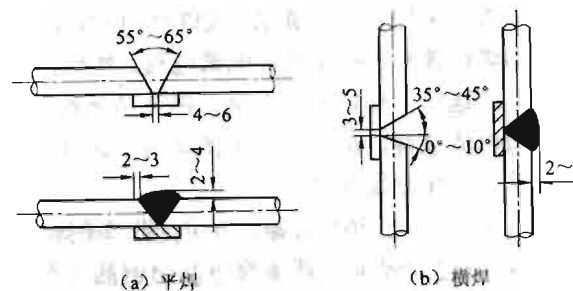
钢筋坡口焊接头 (单位: mm)
